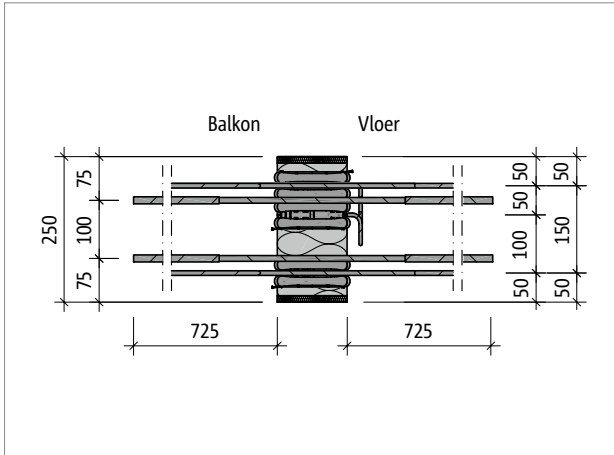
Schöck Isokorf® XT type K-E-M8: Bovenaanzicht
